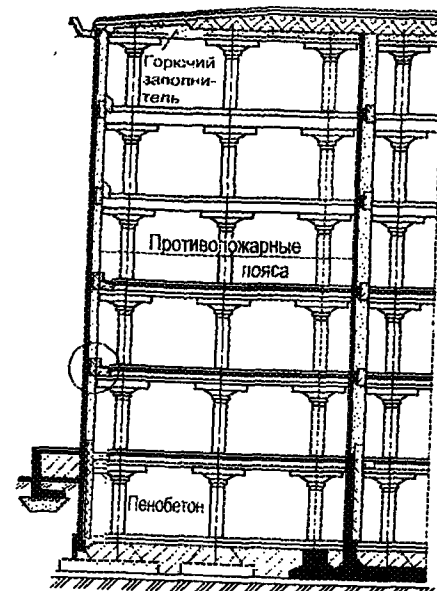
Устройство противопожарных поясов у наружной и внутренних стен холодильника
